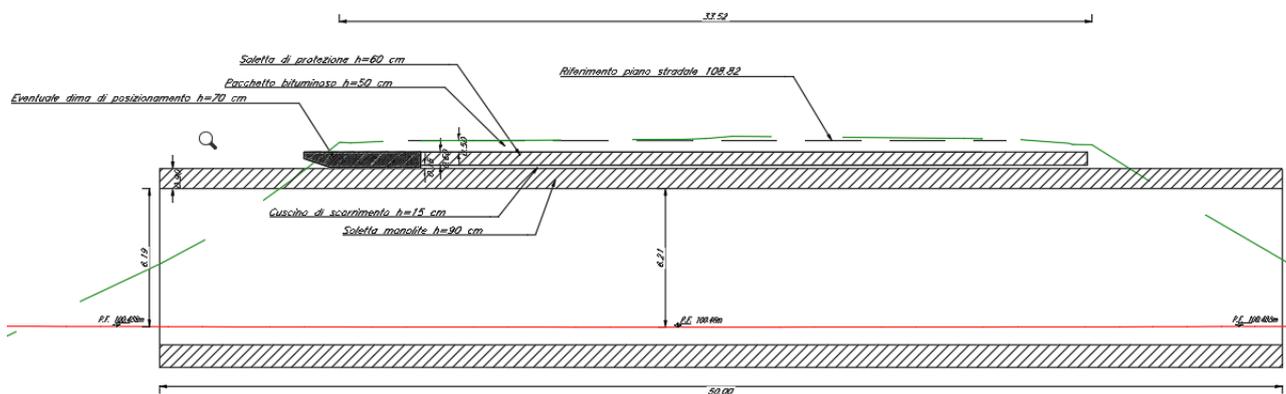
Sezione longitudinale galleria artificiale, fase finale con spinta conclusa.
